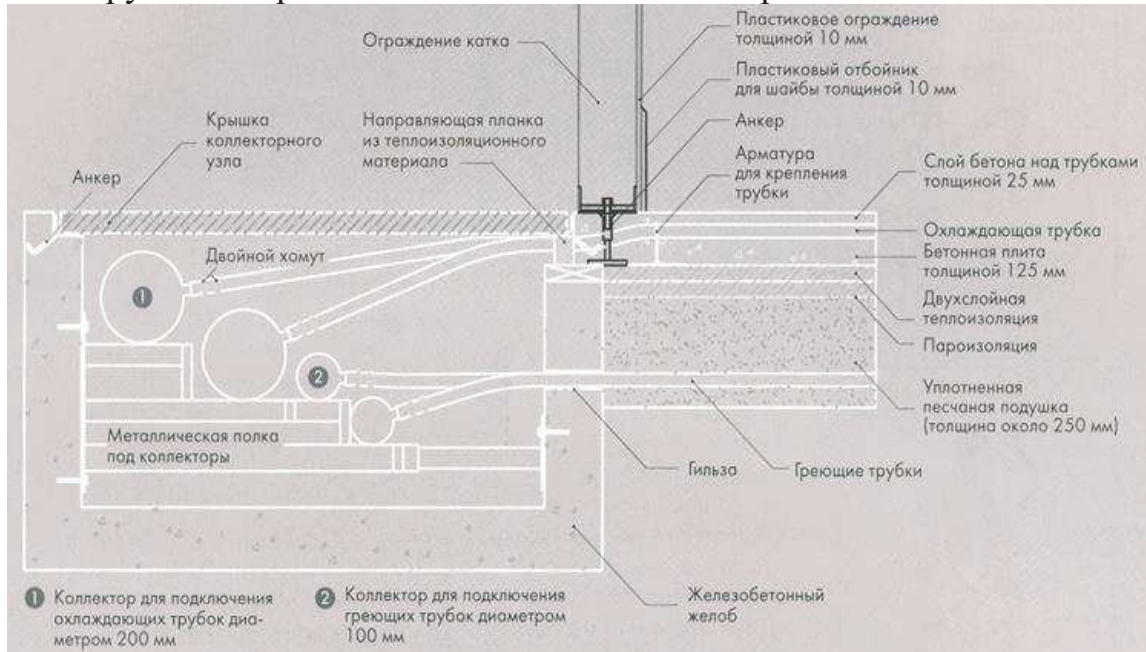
Схема подогрева покрытия грунта в разрезе.
